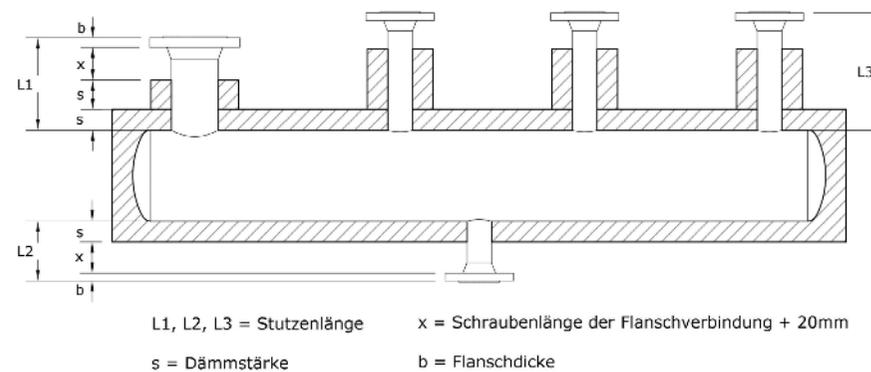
Abstände unter Berücksichtigung der Schraubenlängen bei Flanschen
